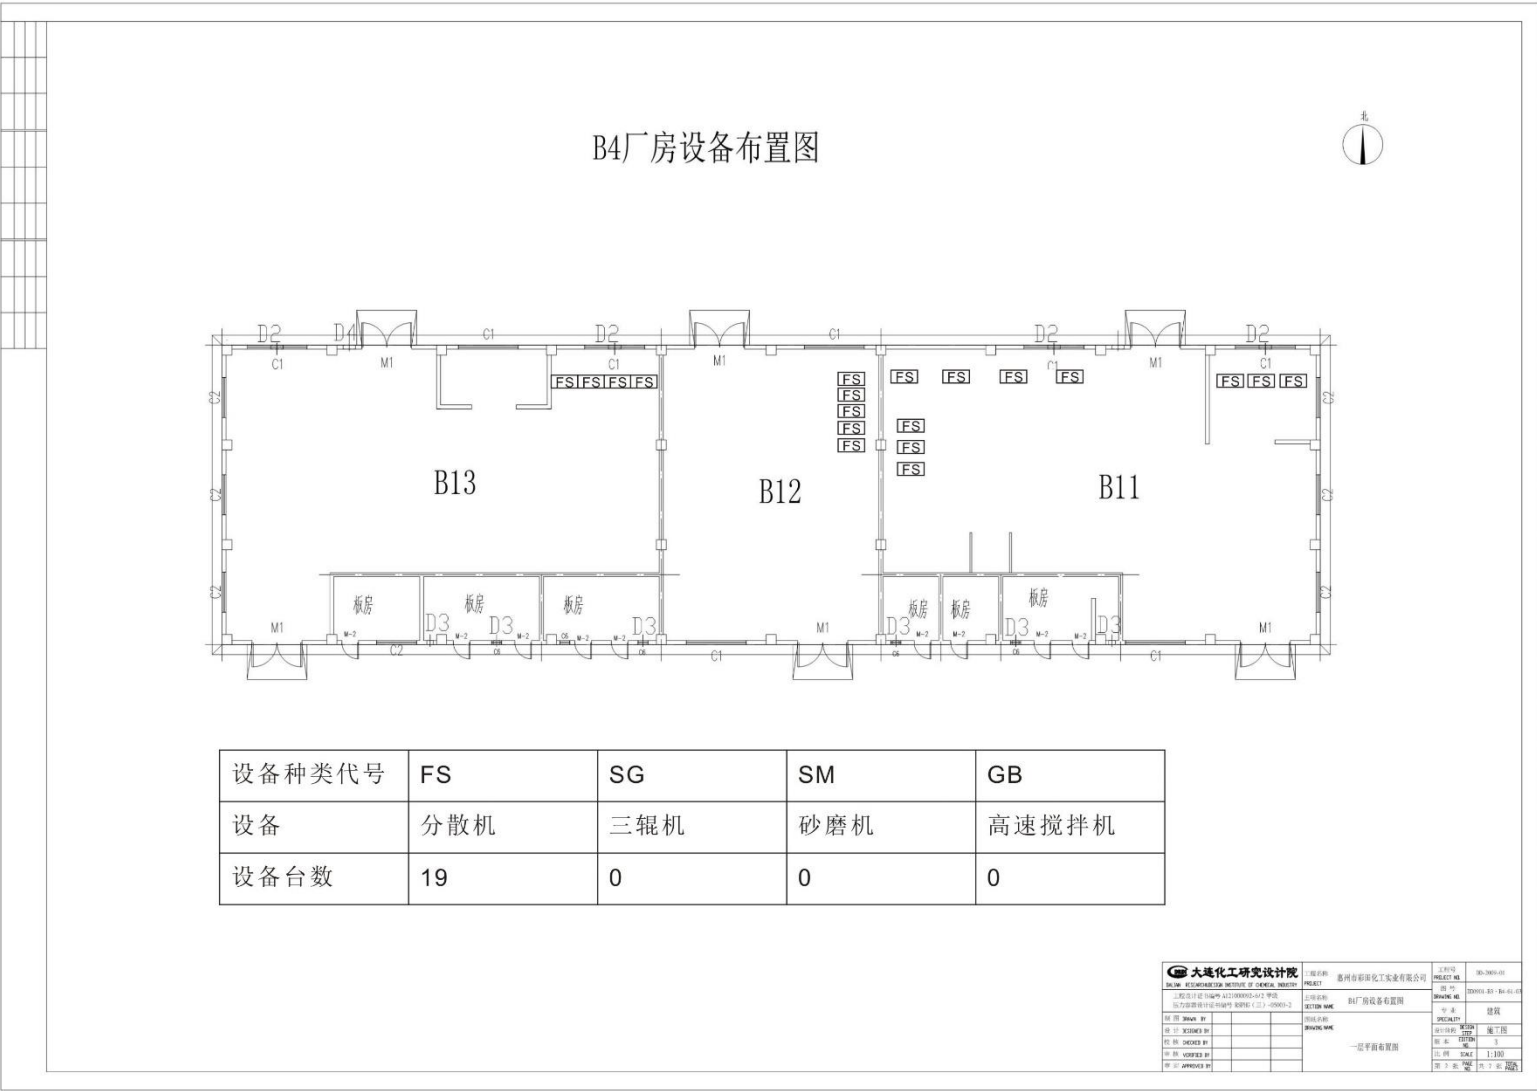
现有项目车间平面布置图 (B4 厂房)
